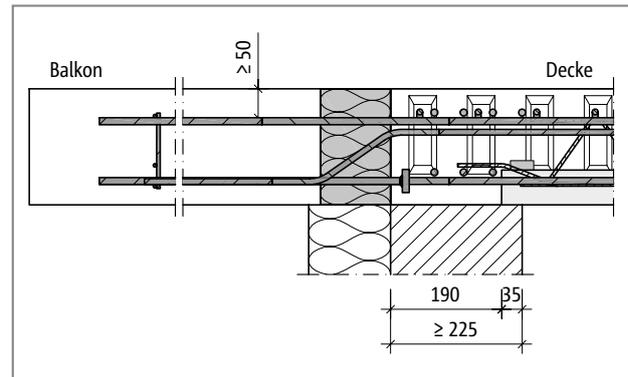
Schöck Isokorb® Typ EXT: Elementplatte ohne Randunterstützung mit WDVS (Schnitt EXT-R-CV50, Ansicht EXT-L-CV35)
